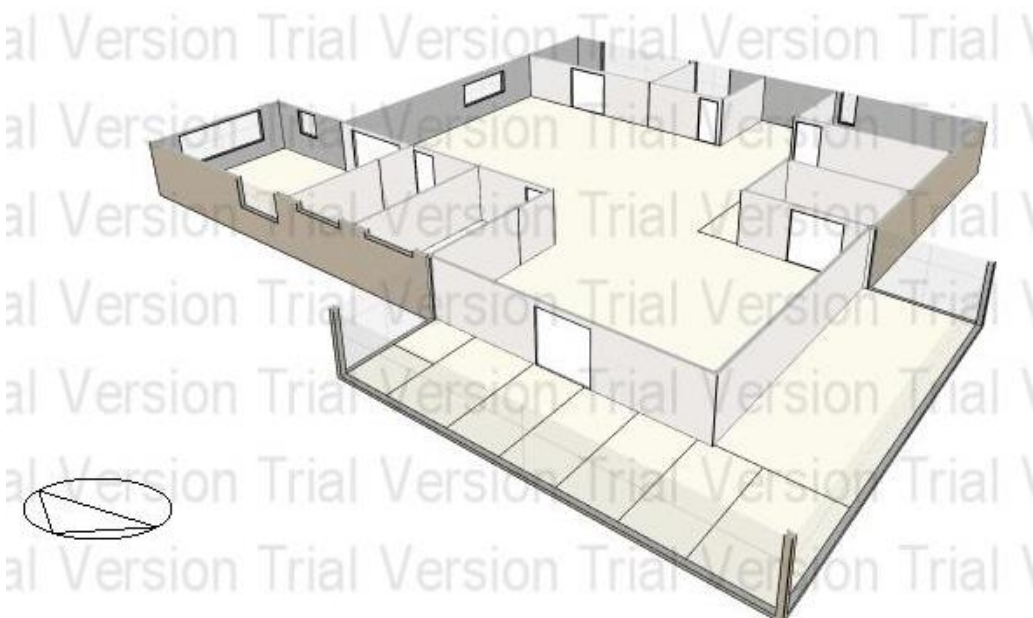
Diseño segunda planta prototipo. Design Builder. Fuente propia
